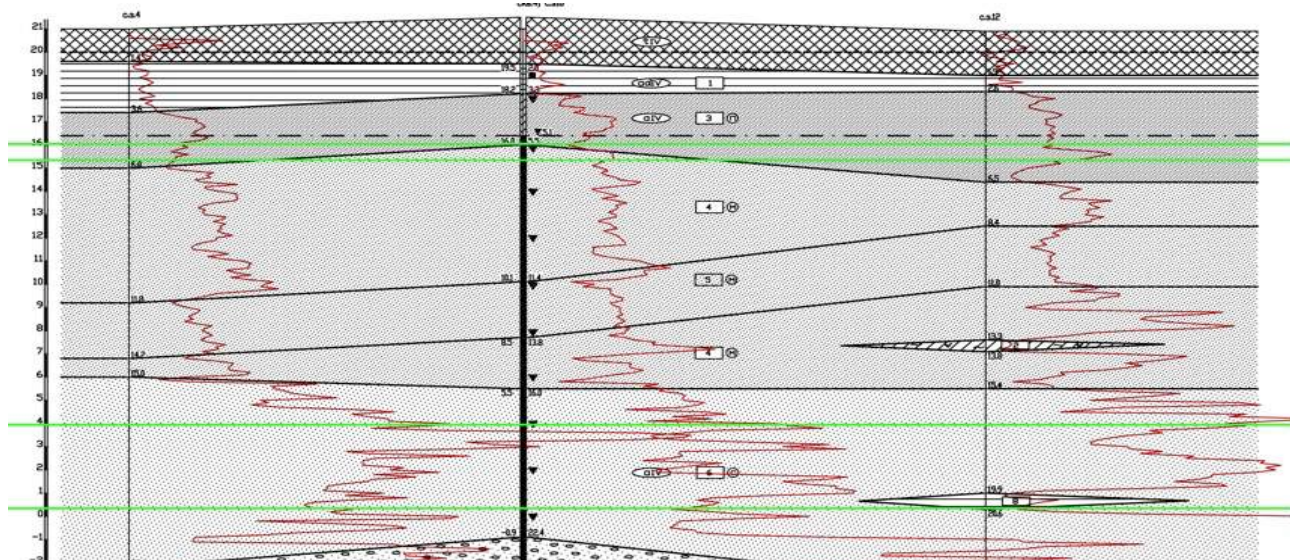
Геологический разрез опытной площадки №2 (г. Краснодар)
